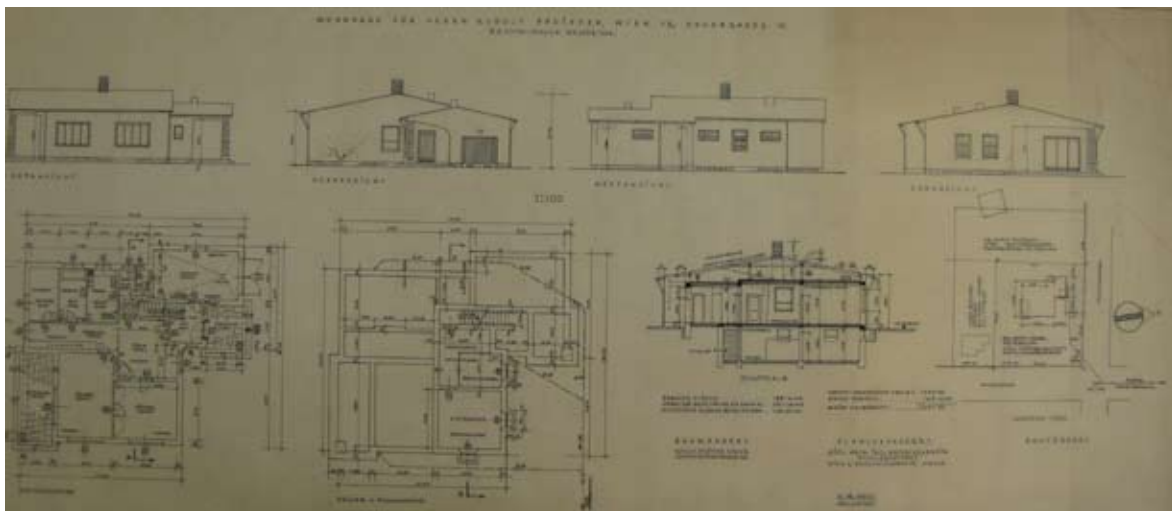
Plan 27.8: Anton Valentin. Wohnhaus für Herrn Rudolf Pfeiffer, Wien 13, Hauergasse 15. E.Z. 3770 – Mauer K.Z. 1234/101. Ansichten, Schnitt und Grundriss. Pl. Nr. 8810. Maßstab 1:100. Juni 1956.
